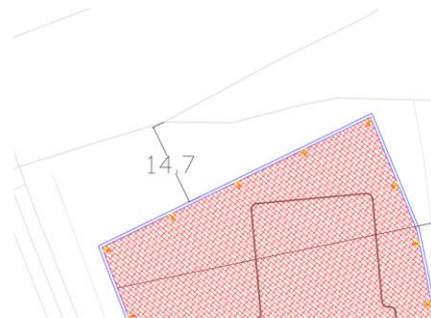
Stralcio Planimetrico – distanza minima incisione-piazzale di progetto
